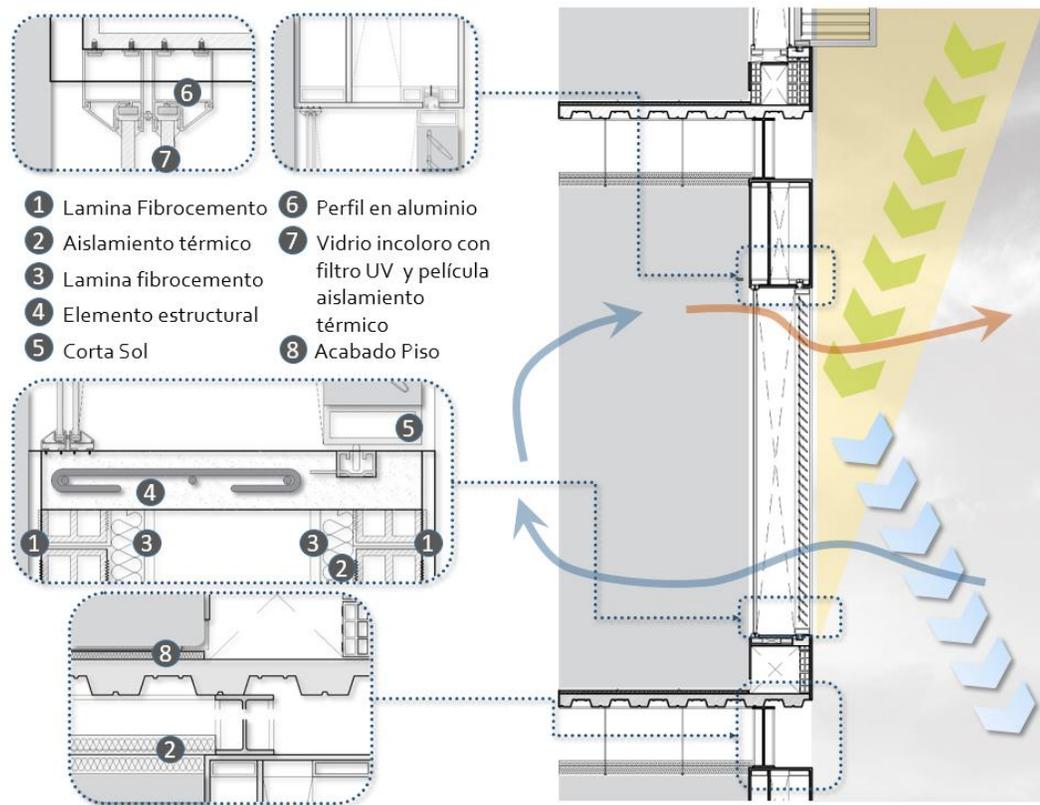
Corte fachada y detalles correspondientes a materialidad en clima frío. (ver anexo – “Detalle corte fachada”)
